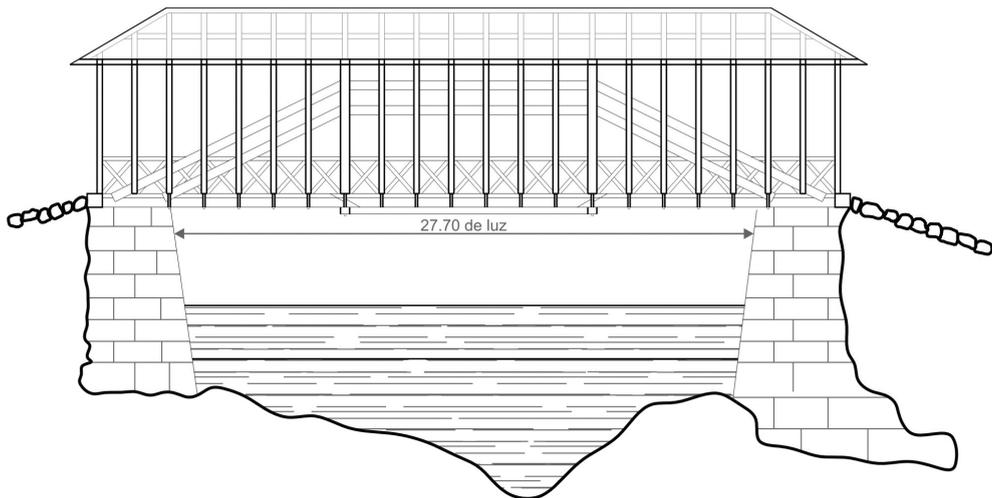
Croquis del puente de Victoria, sobre el río Guarinó (corte longitudinal). Fuente: elaboración propia a partir del plano existente en el Archivo General de la Nación (Bogotá), Fondo Ministerio de Obras Públicas, vol. 1483, f. 408
